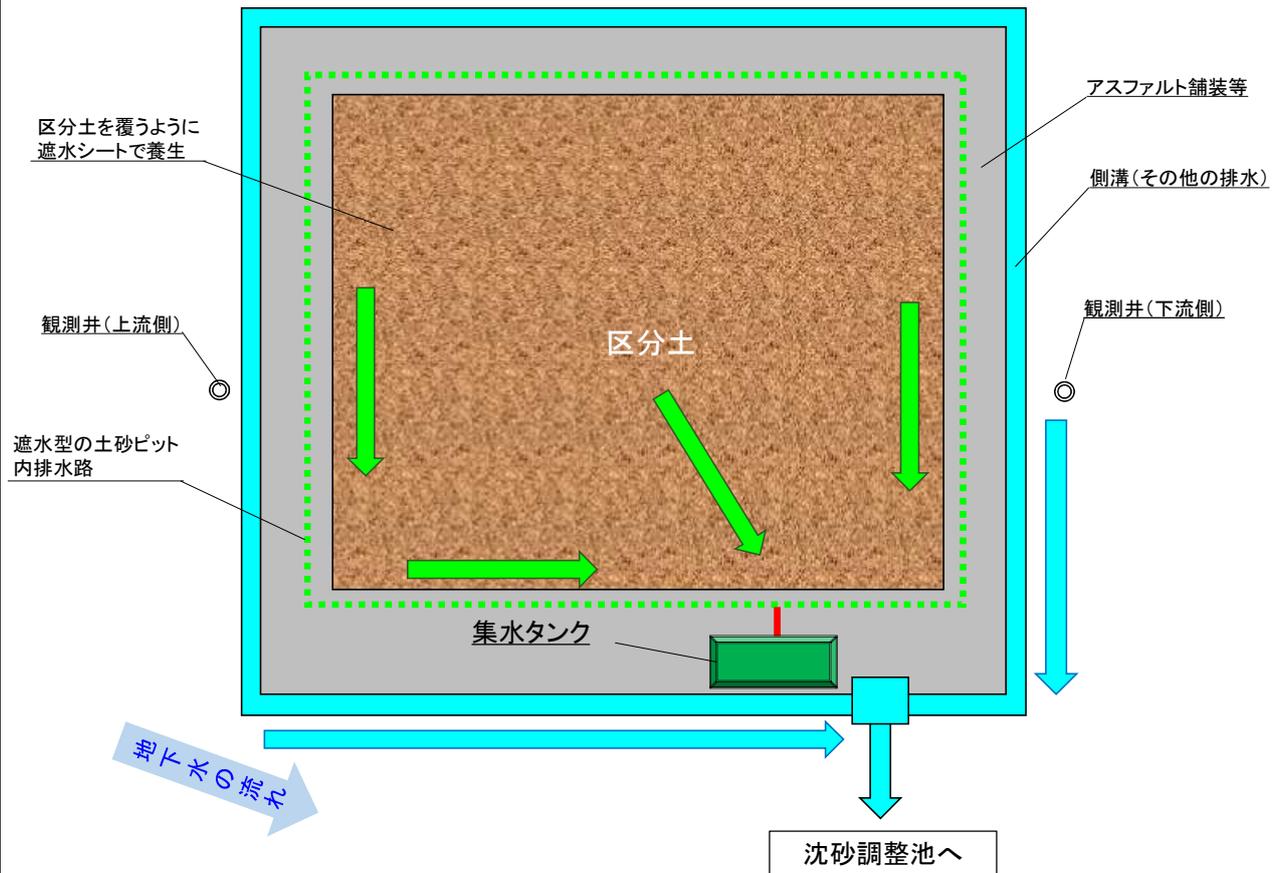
トンネル掘削時の工事施工ヤード内設備配置図
